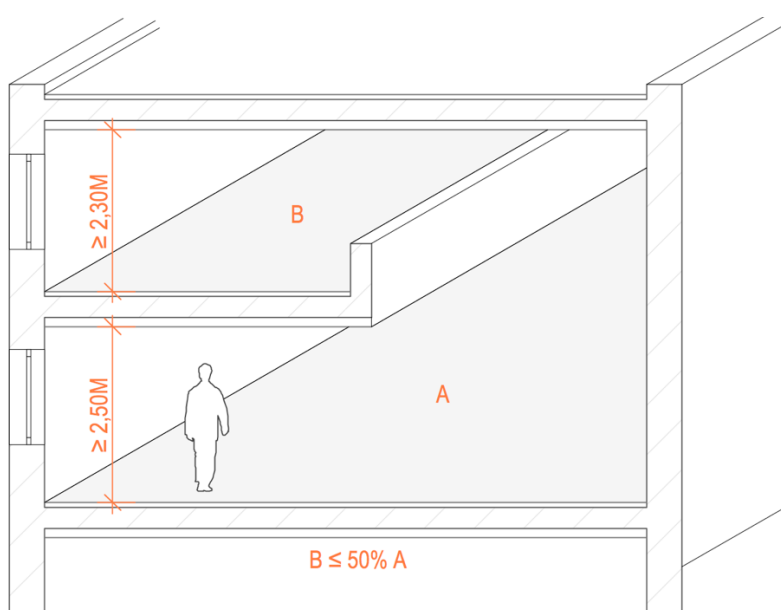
Hauteur libre sous plafond d'une mezzanine ou d'un comble
